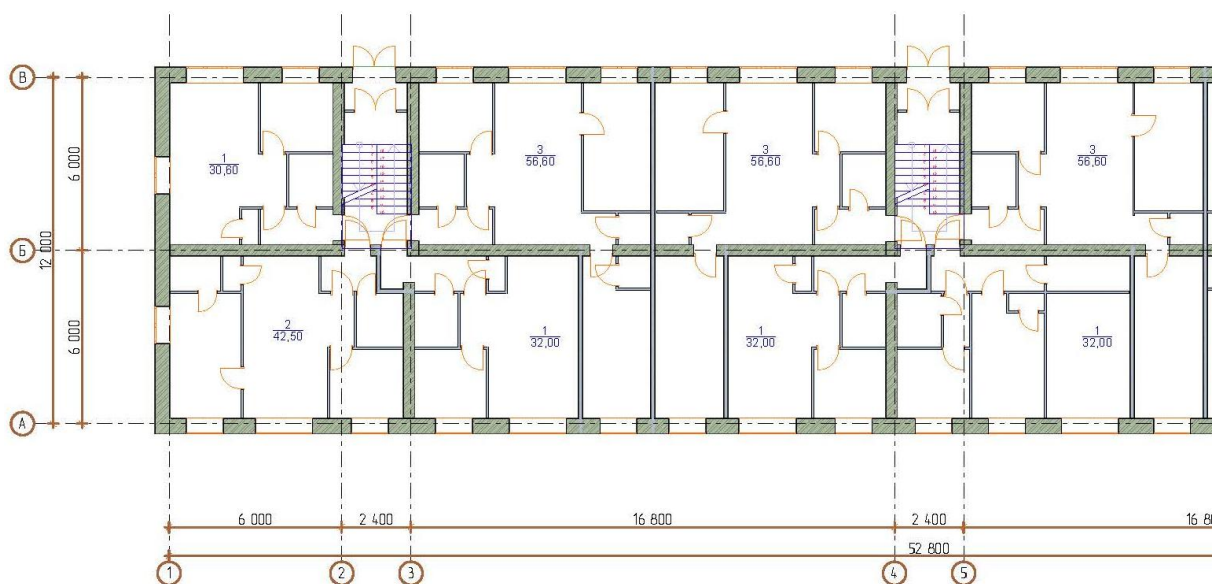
Планировка 1-го этажа серия 1-447С-8.
